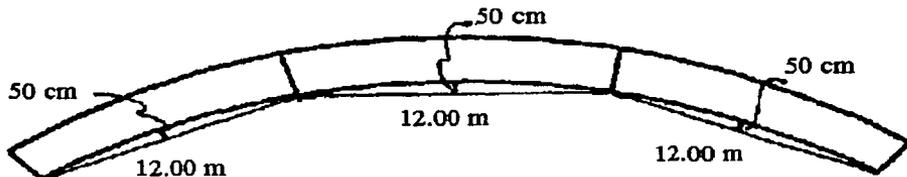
TRAMO DE TUBOS SOLDADOS (LINGADA)
